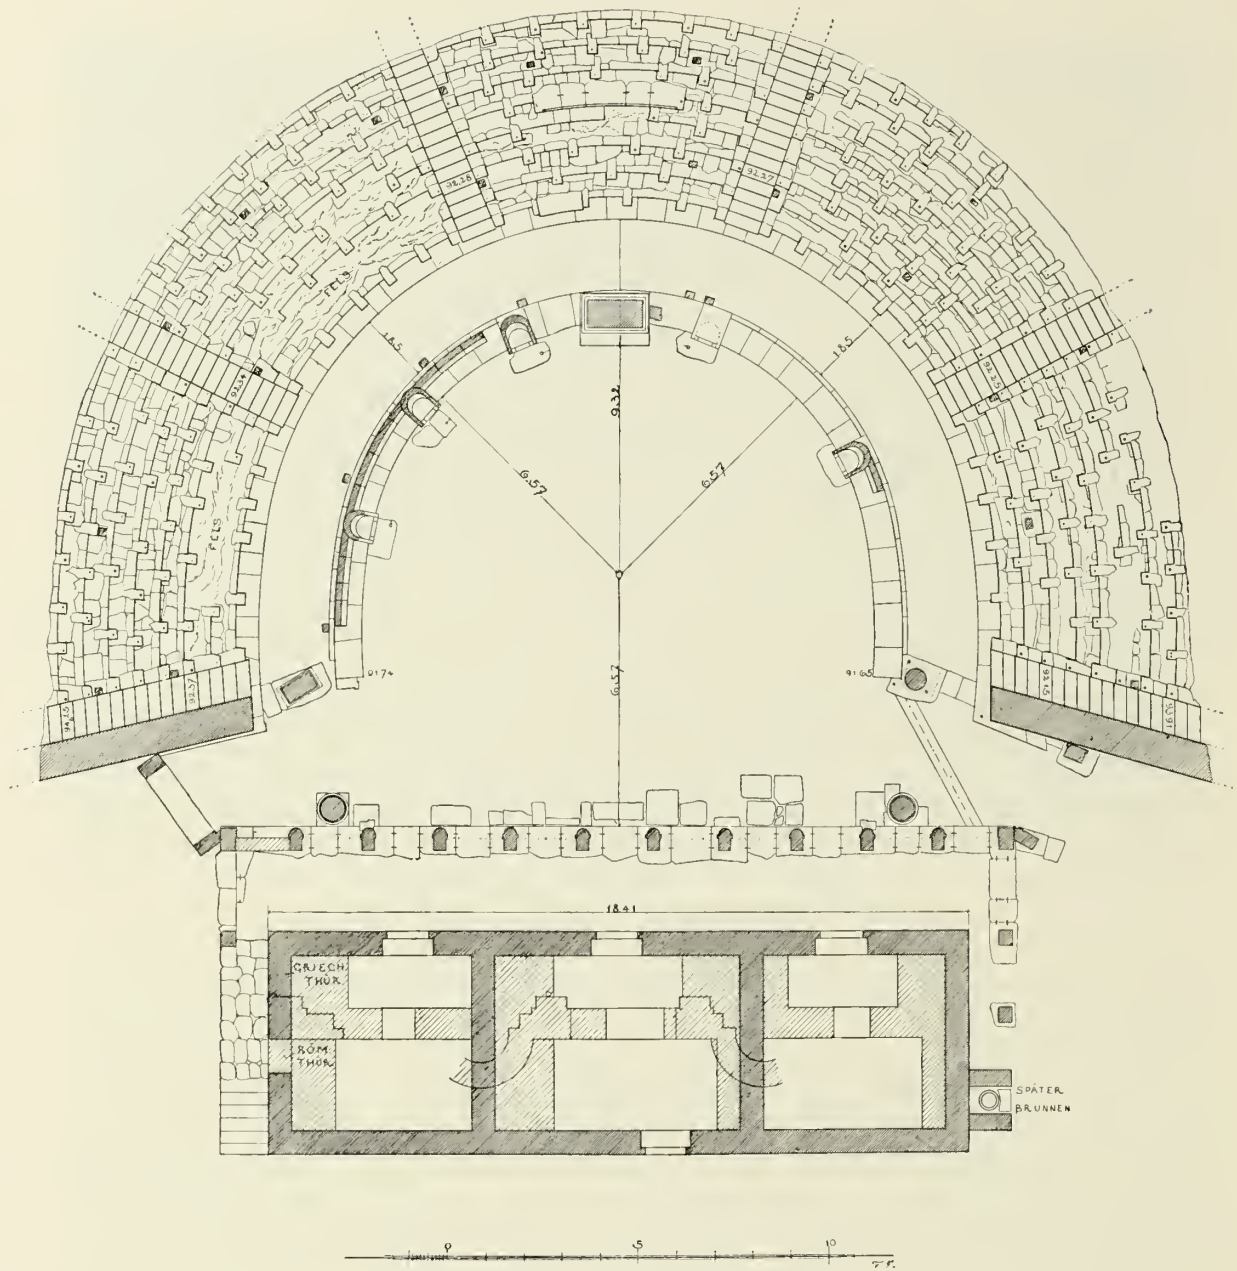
Grundriss des Theaters. Erhaltungszustand.
